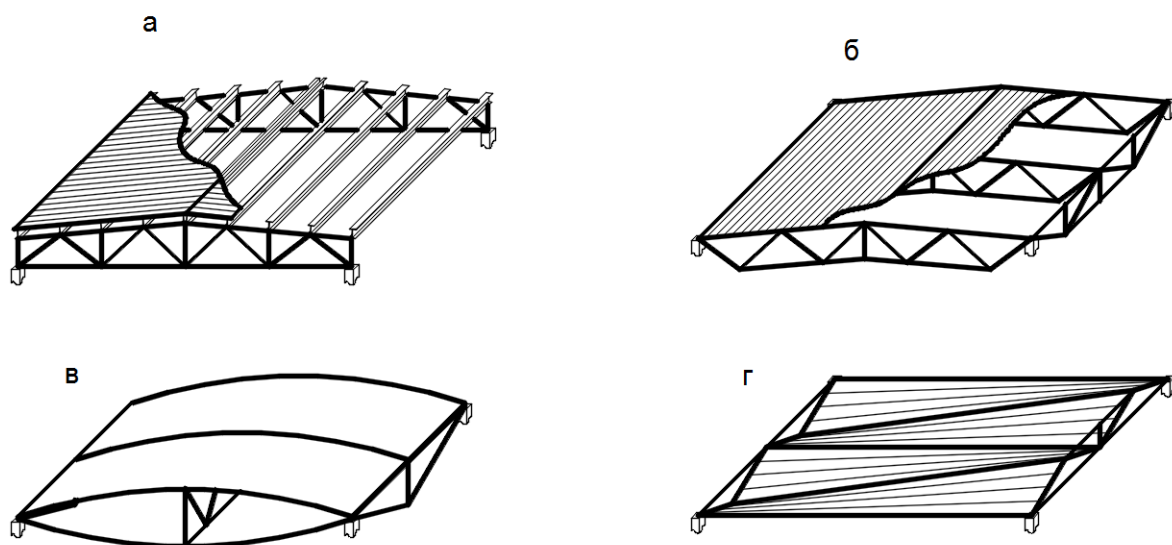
Конструктивные варианты покрытий: а- прогонное покрытие; б- беспрогонное покрытие; в- покрытие из цилиндрических панелей-оболочек; г- покрытие из гиперболических панелей-оболочек «на пролёт»; 1- стропильные фермы; 2- прогоны; 3- профилированный настил; 4- подстропильная ферма; 5- цилиндрические панели покрытия; 6- гиперболические панели-оболочки; 7- распорки.
